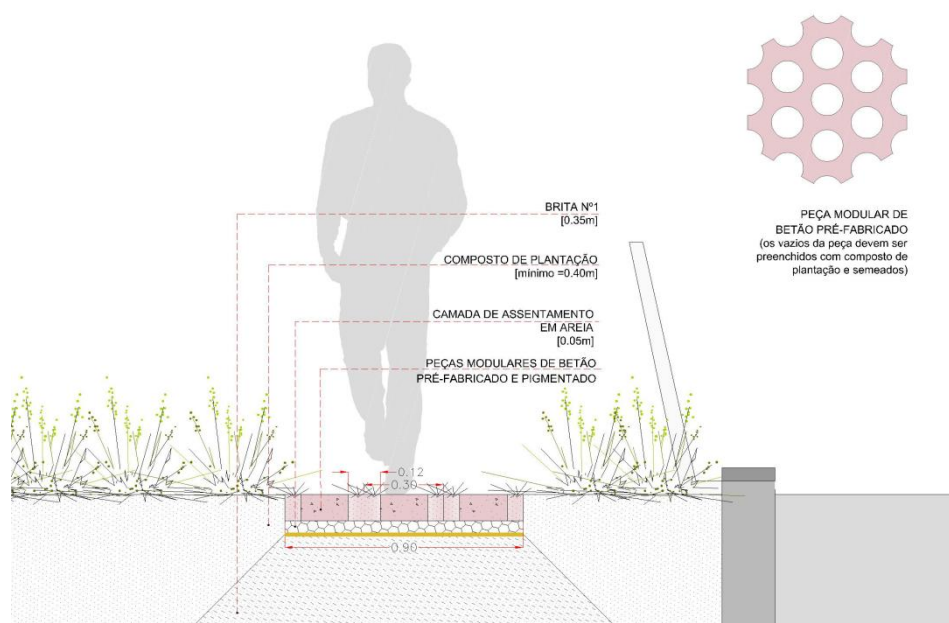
Pormenor construtivo dos módulos em betão pré-fabricado a aplicar no jardim de cobertura
